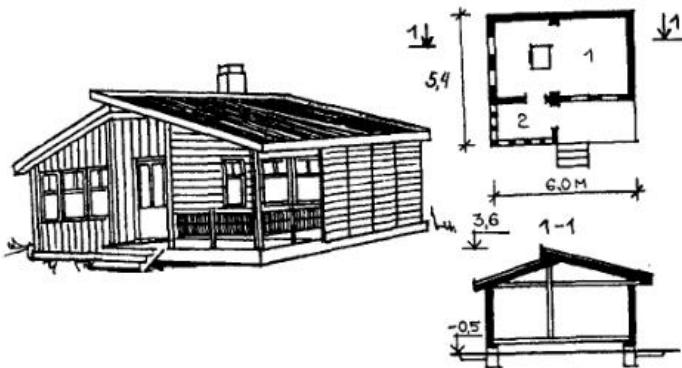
Садовый домик со стенами из деревянно-панельных конструкций. Состав помещений: 1 — комната — 20,59 м<sup>2</sup>, 2 — веранда — 3,87 м<sup>2</sup>. Строительные конструкции: стены — деревянные панели; крыша — совмещенная; кровля — асбестоцементные листы. Расход основных строительных материалов: цемент М-400 — 1,25 т, сталь — 0,05 т, бетон М-150 — 3,7 м<sup>3</sup>, кирпич М 75 — 0,48 тыс. шт., лесоматериалы — 11,08 м<sup>3</sup>.
